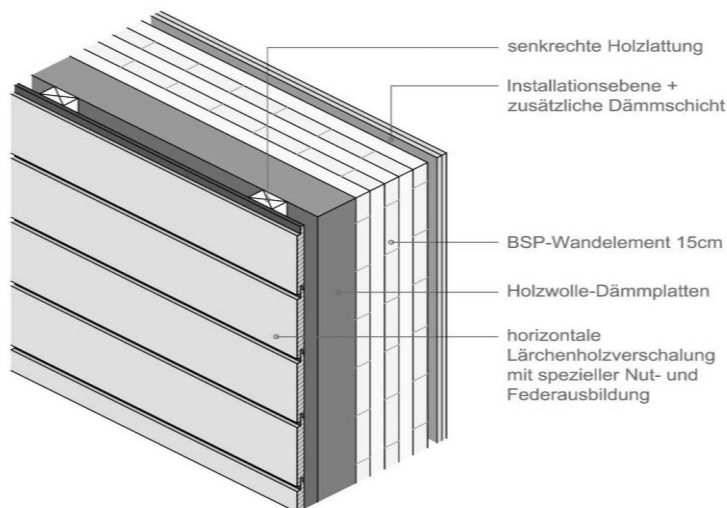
Querschnitt Wandaufbau Aussenwand
